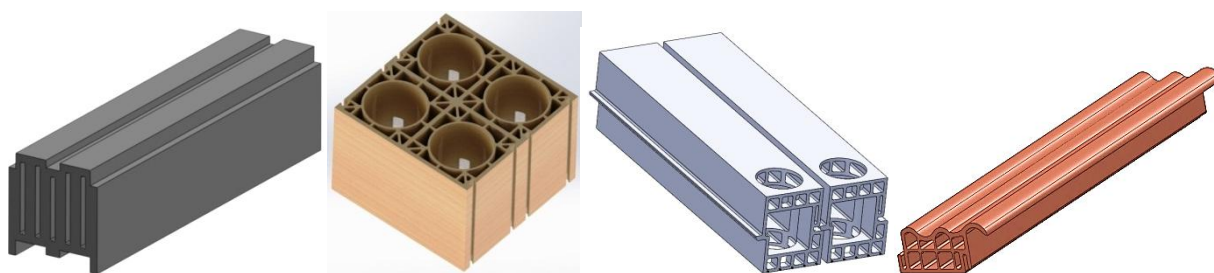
Отдельные элементы универсального набора (слева-направо: фундаментный блок, рядовой стеновой блок, балка перекрытия, кровельная плита)
